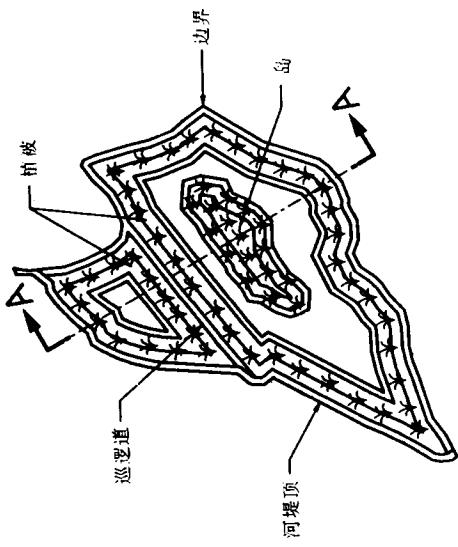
弃置河曲管理和混凝土草面应用断面示意图
